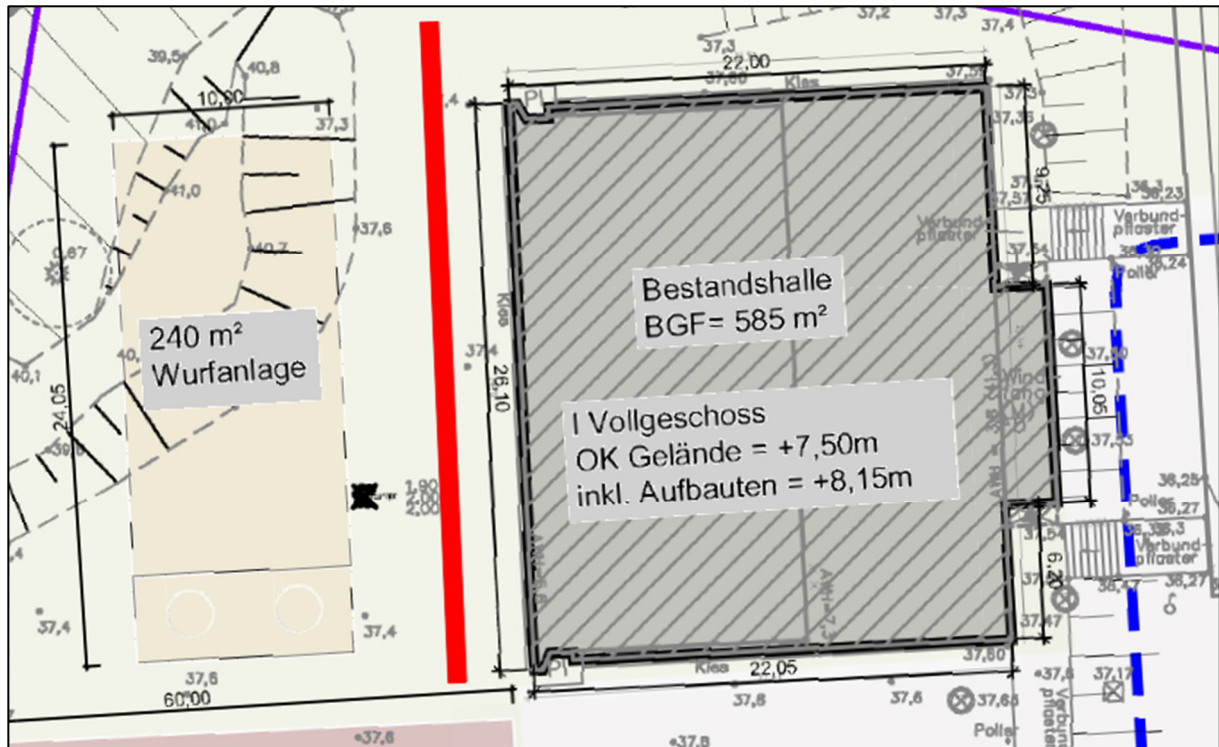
Lage Rigole Dachflächen – Bestandshalle Außenanlagenplanung Variante 1
